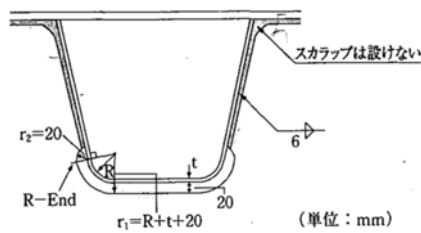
閉断面リブと中間横リブ又は横桁との交差部構造の標準
